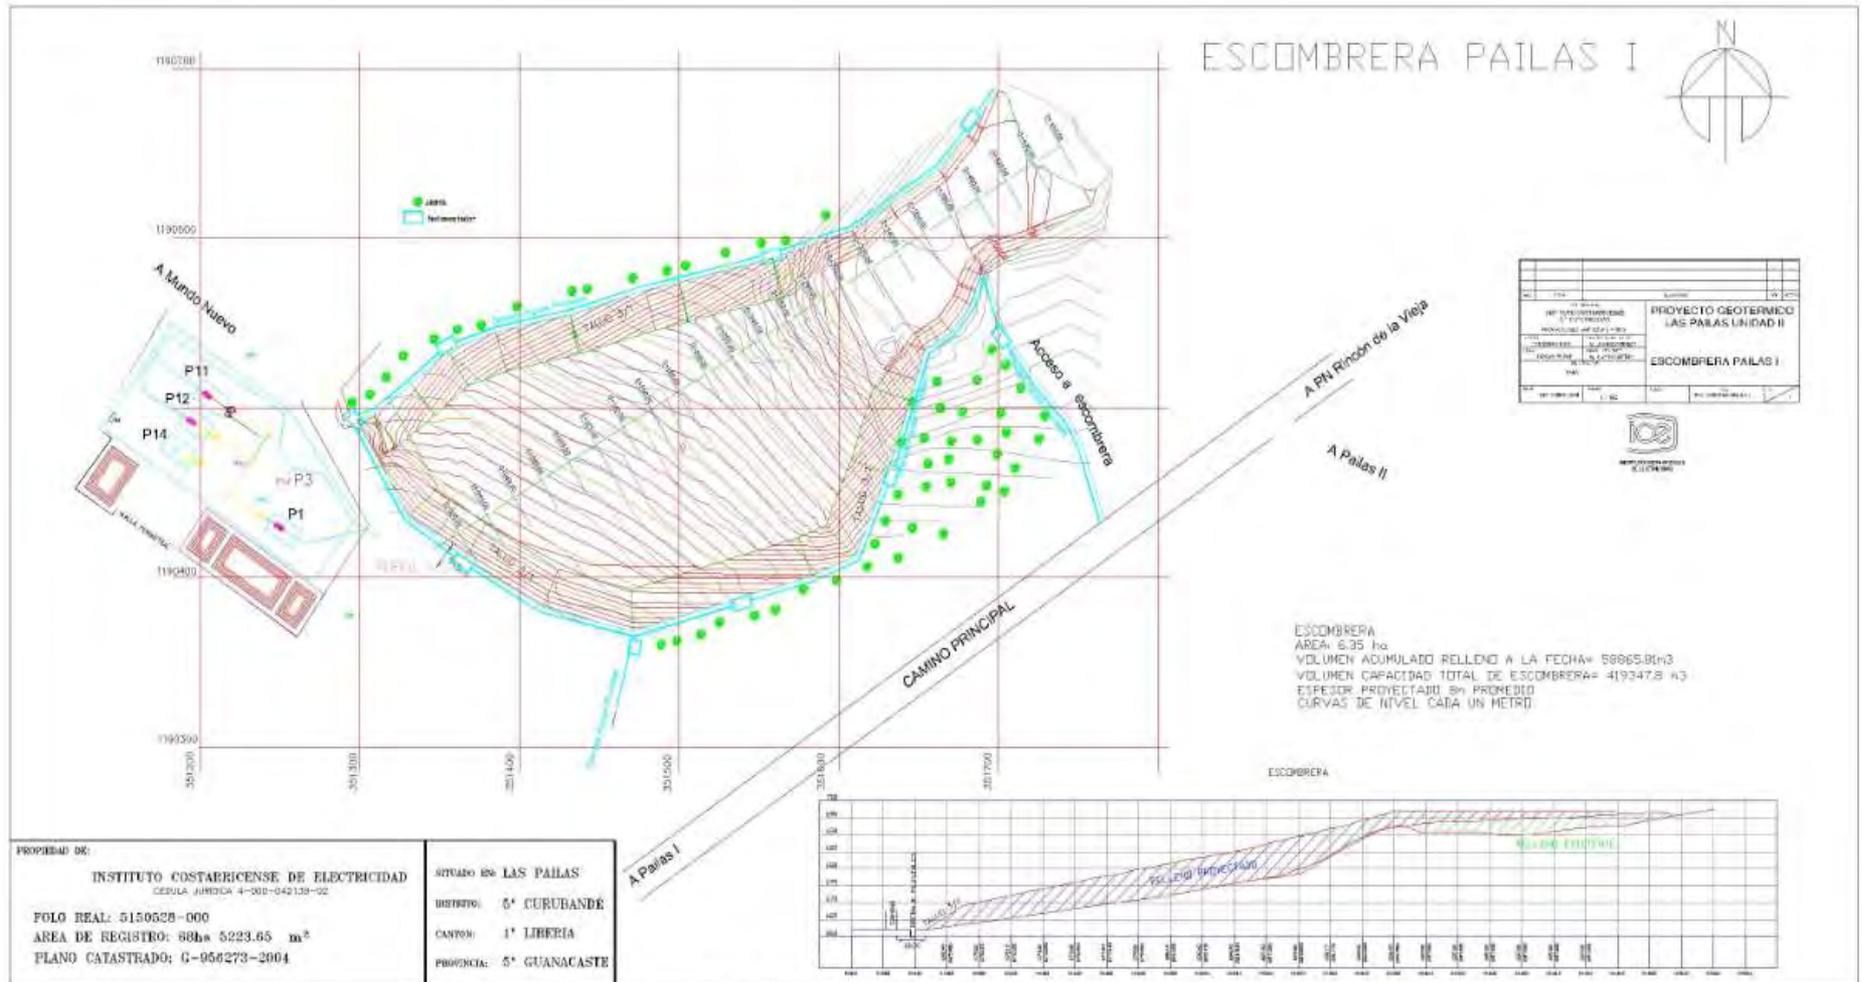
Plano Topográfico de la Escombrera Pailas I.
